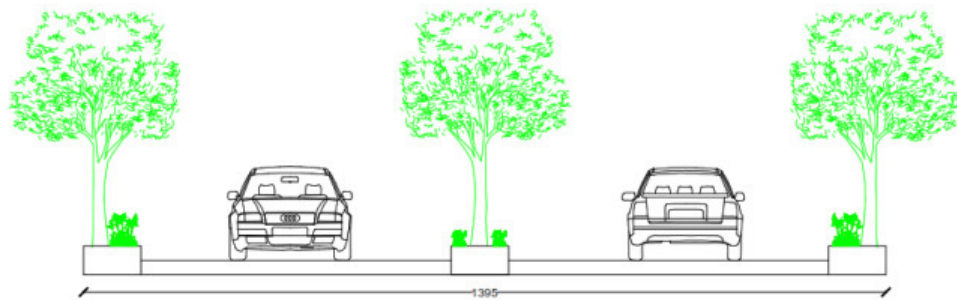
Potongan Melintang Jalan Pada Sekolah Telkom Zona 1
